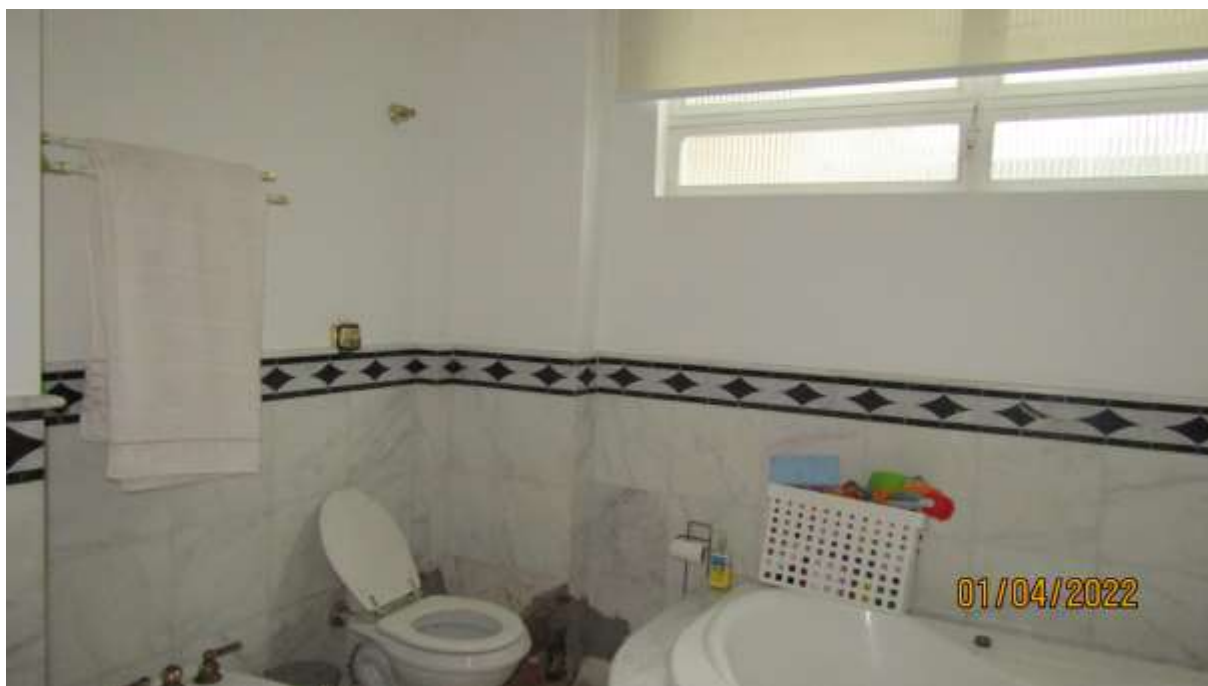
Detalhes do wc da suíte máster do apartamento 51.
